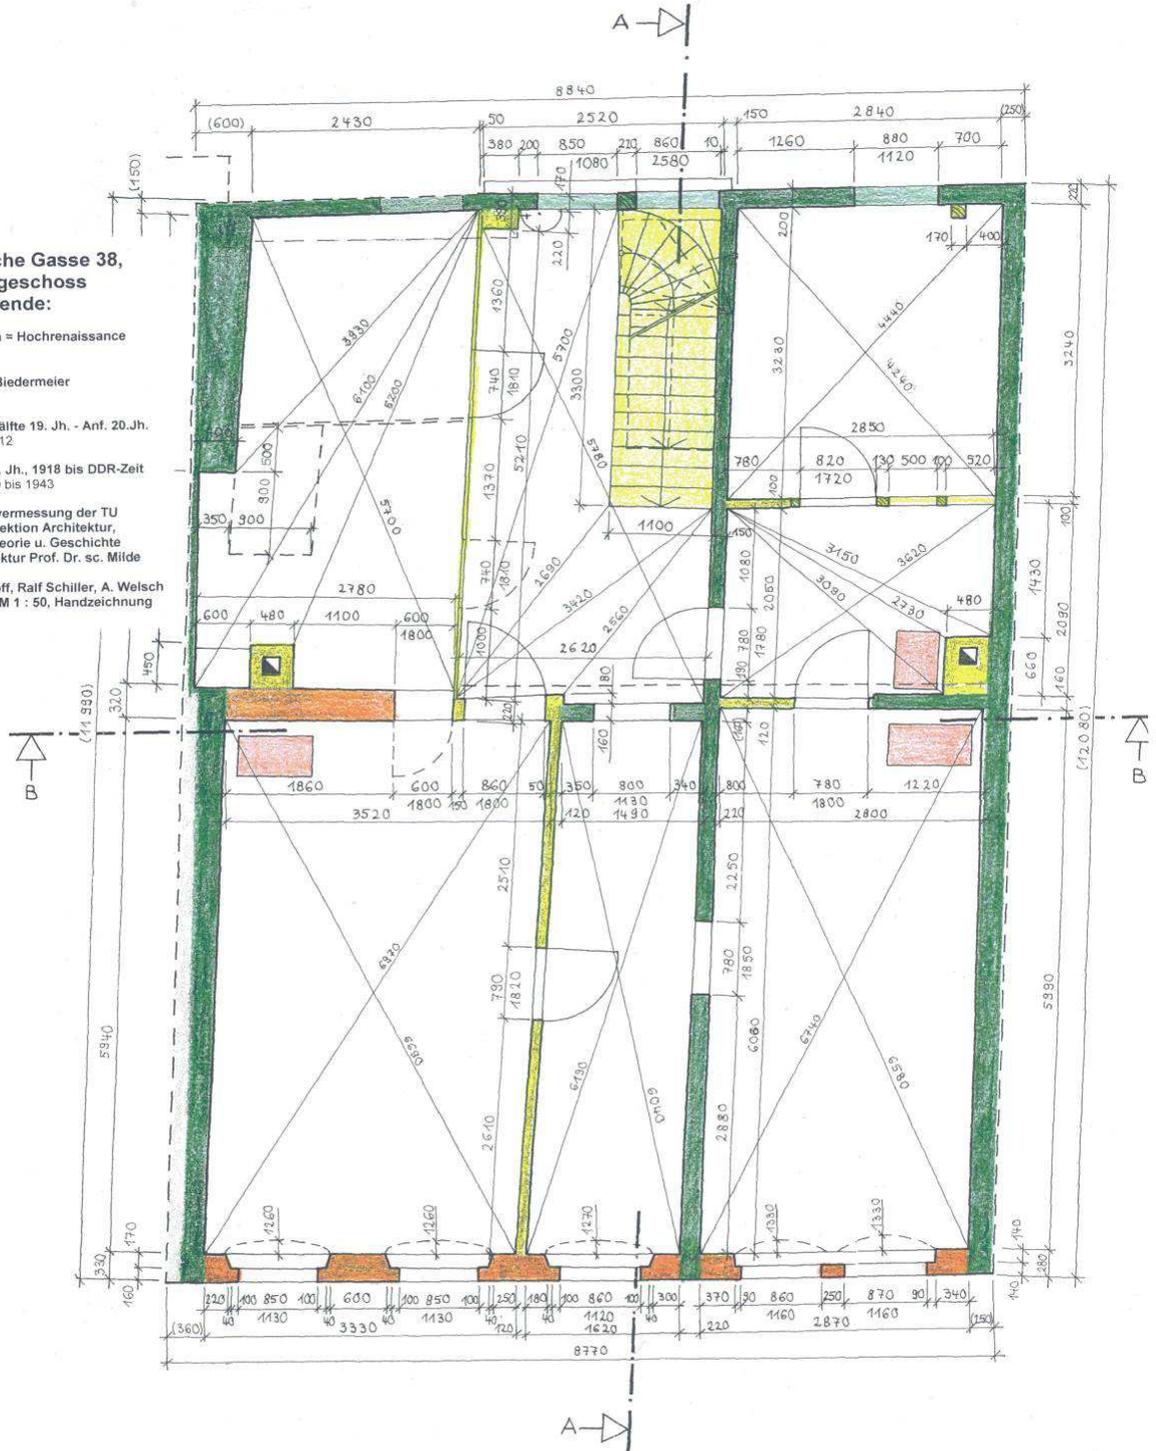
Görnische Gasse 38: Baualtersplan Grundriss Obergeschoss
